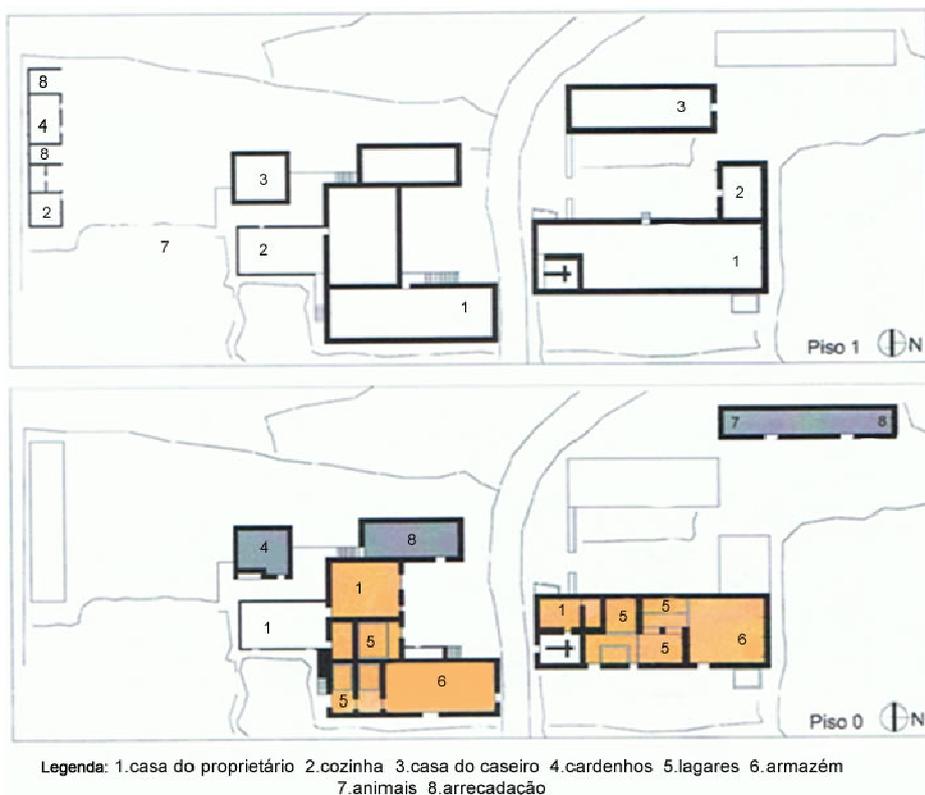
Planta da Quinta do Lodeiro (retirado de [4])
